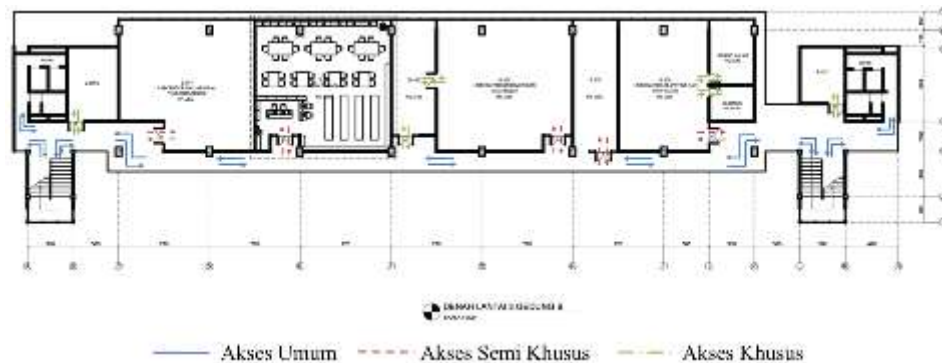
Sirkulasi Gedung C Lantai 1
